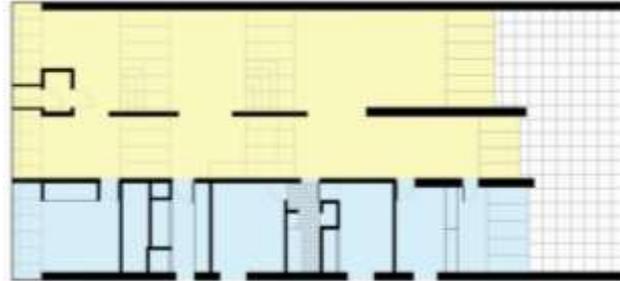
Planta de Jaffe House. Azul: zona privada; Amarillo: zona de día.
